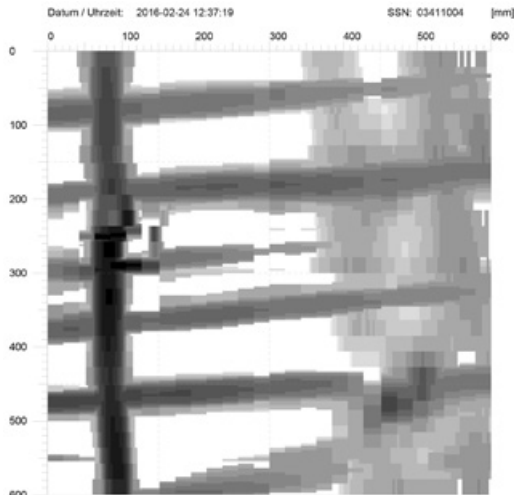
Deutsches Museum: Ablesbare Bügelbewehrung in einem Biegebalken (Foto: JR).
